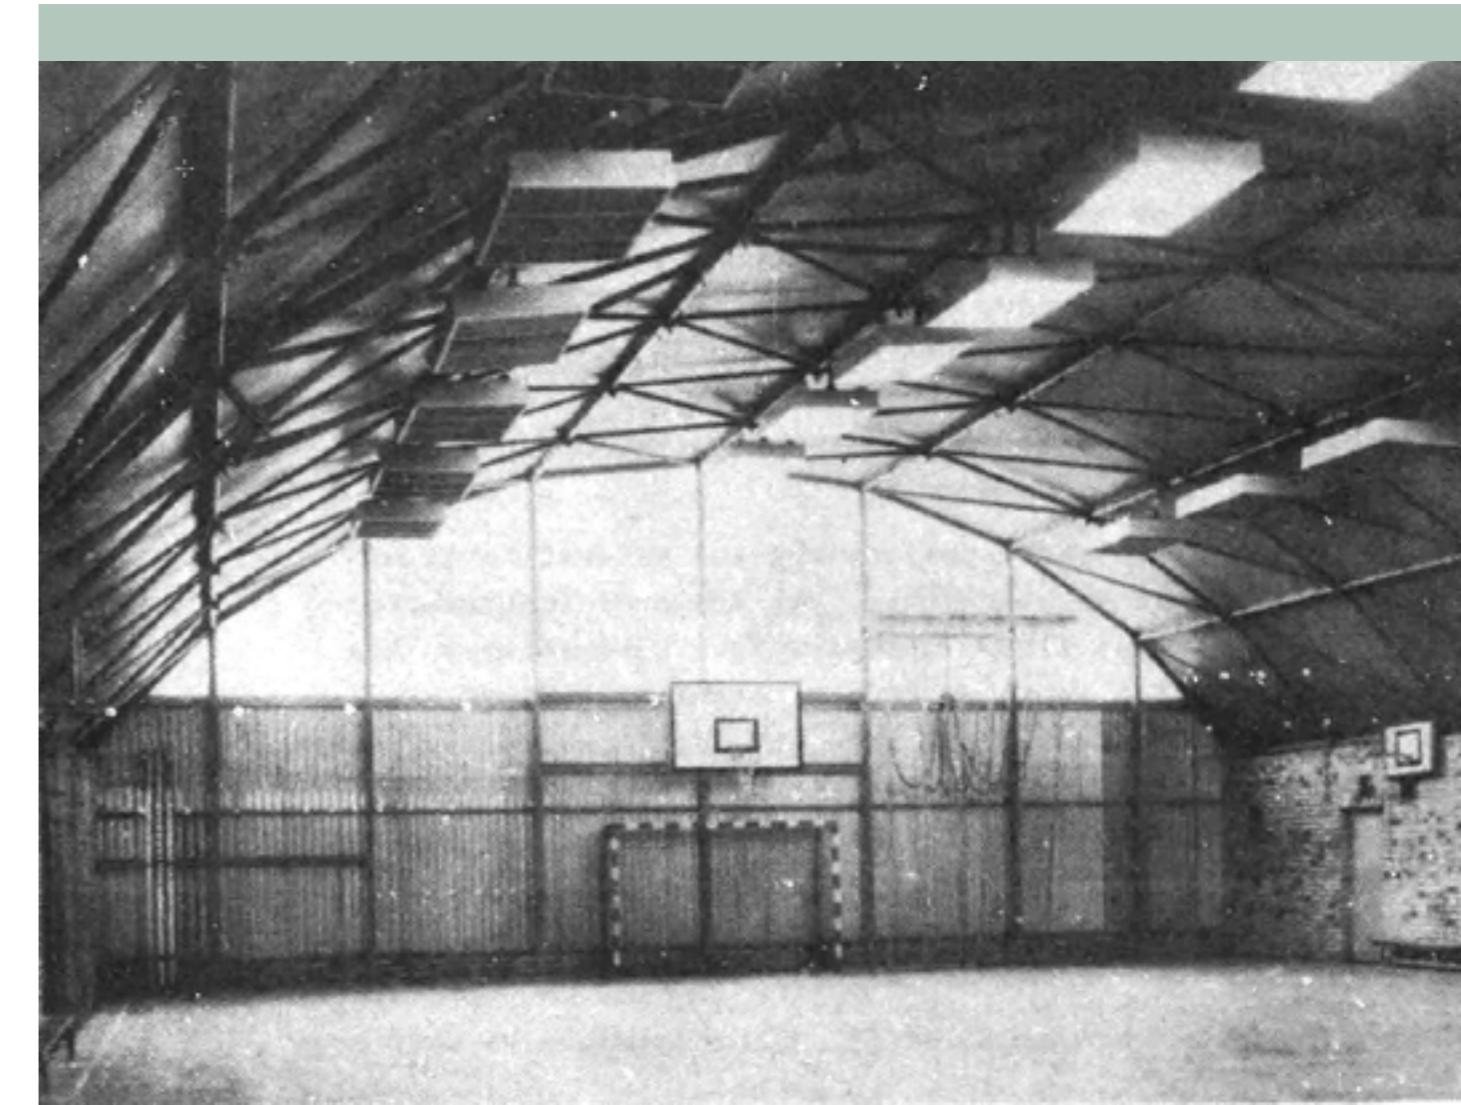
Turnhalle „Sporthalle KT60L/72“
